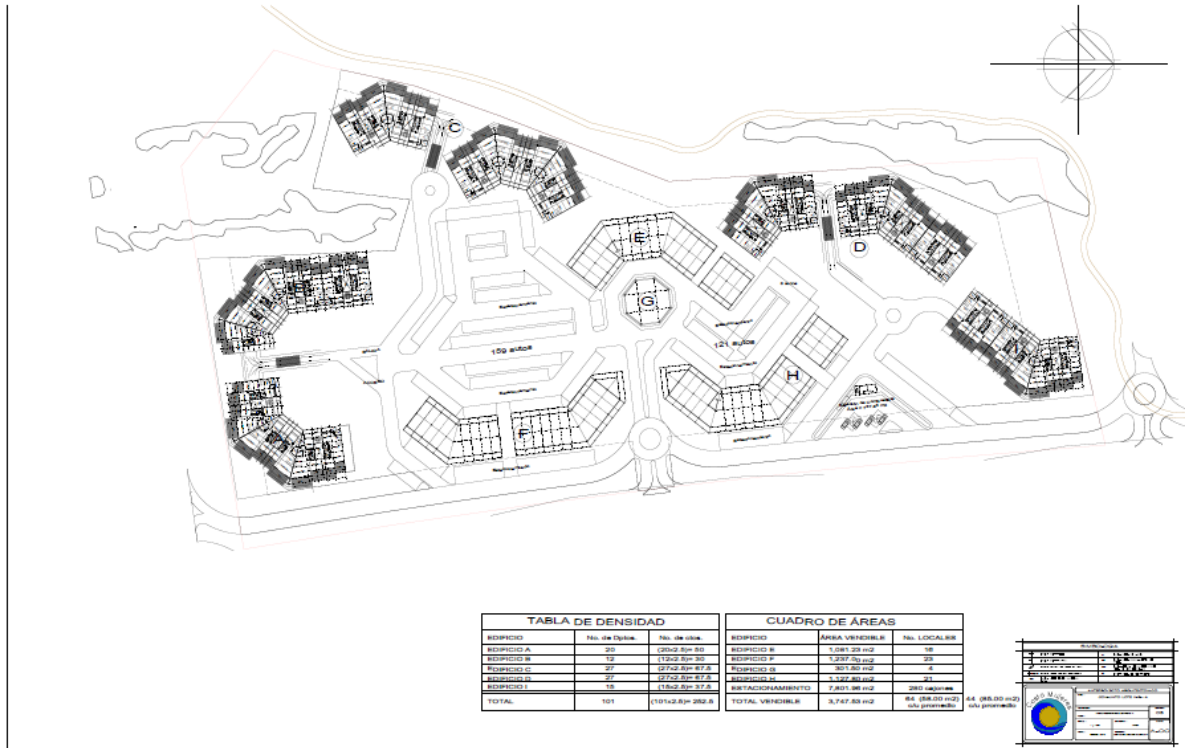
Diseño arquitectónico en vista de planta de las obras que se ubicarán en la Manzana 4 Lote 1 del proyecto.
